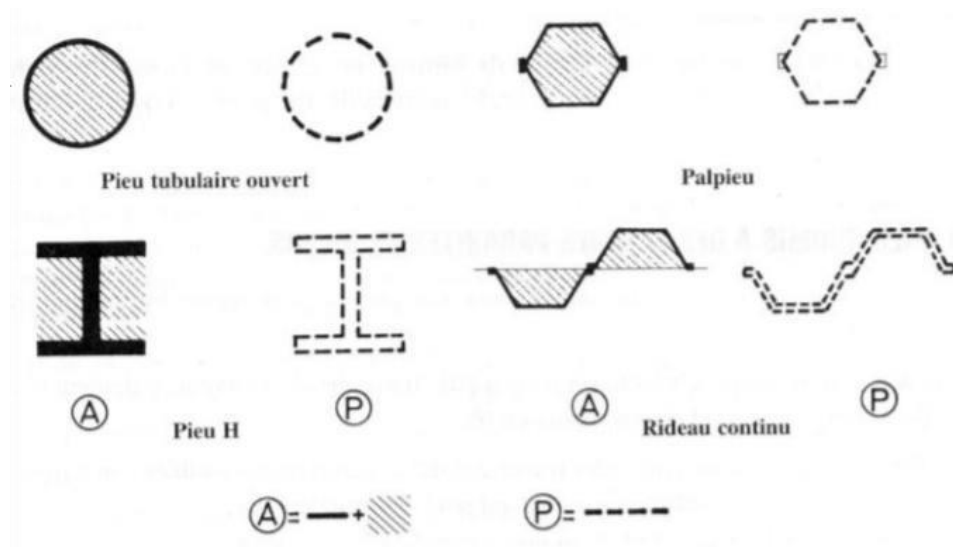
Définition de A et P pour les pieux tubulaires ouverts les palplanches et profilés H.
